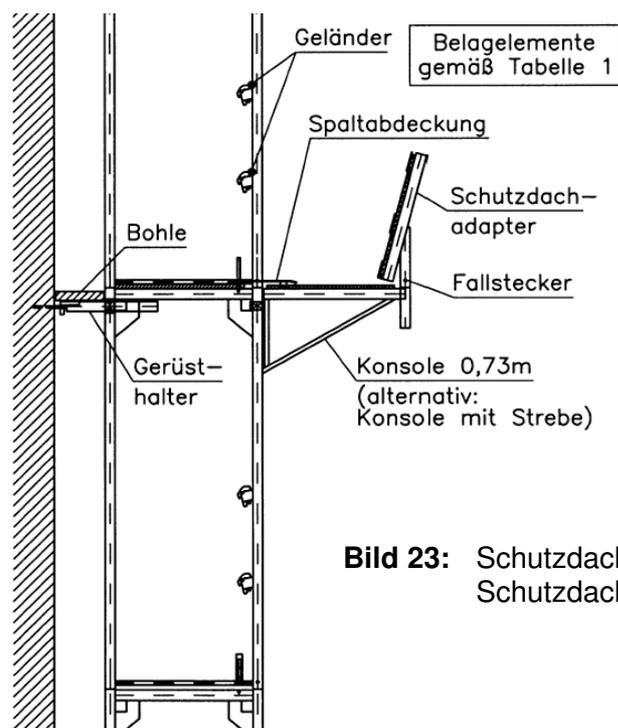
Schutzdach mit Konsolen 73 und Schutzdachadaptern
